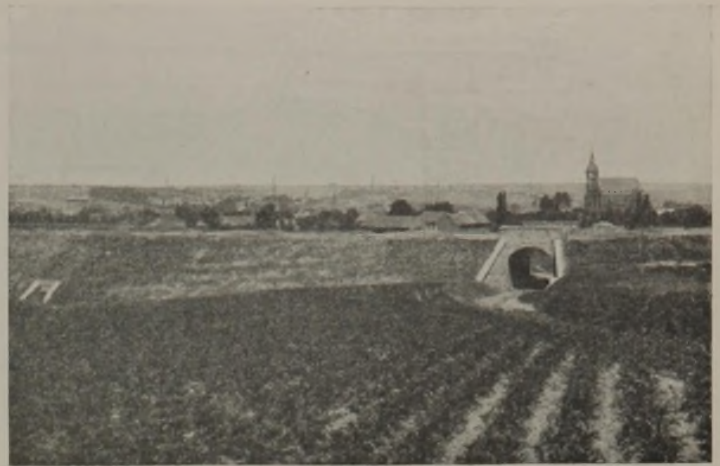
Brücke bei Baustation 15 mit Blick nach der Stadt.
